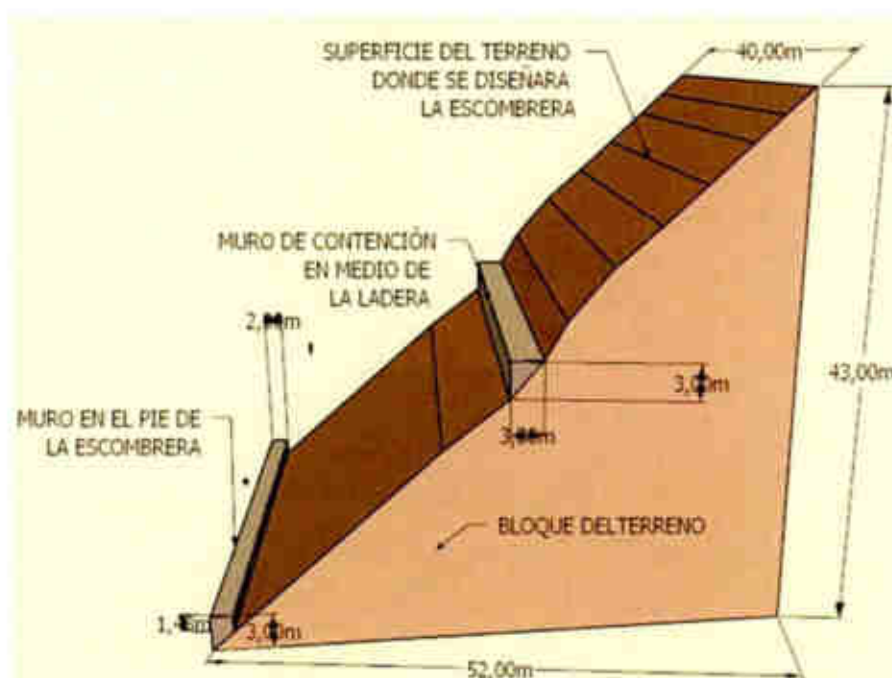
Muros de contención para el reforzamiento del terreno y superficie del terreno donde se dispondrá el material estéril.
